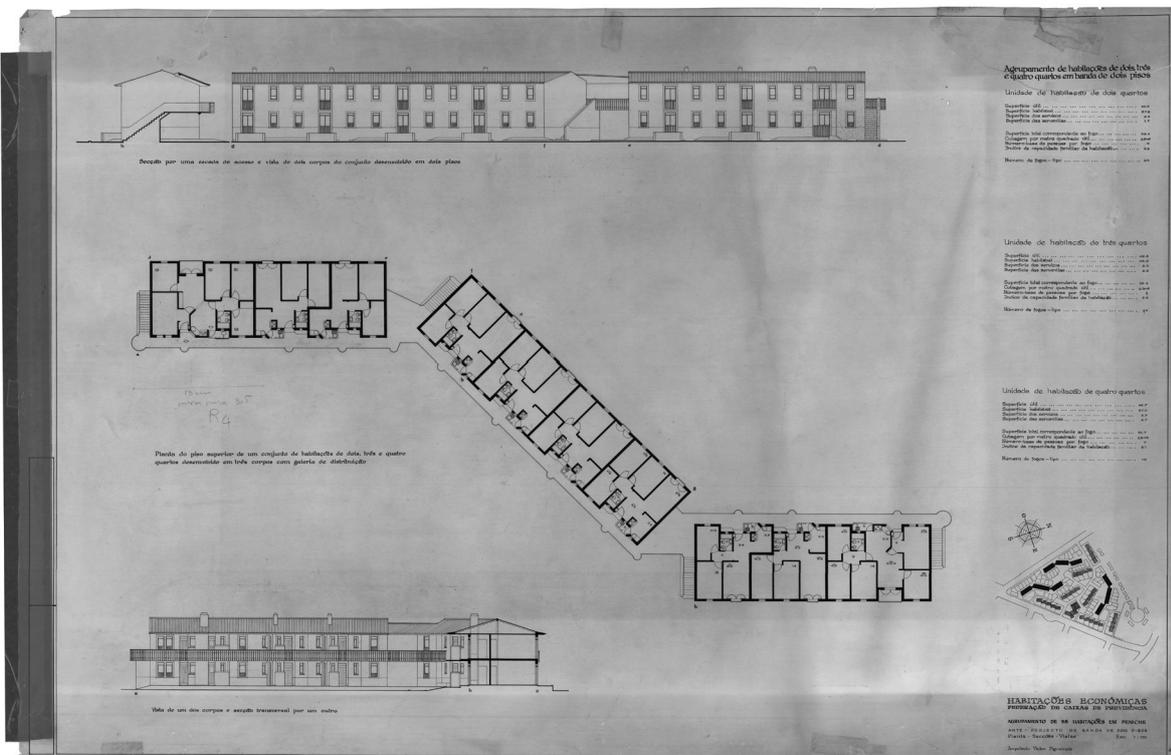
Anteprojeto: banda de 2 pisos - planta, secção e vistas
